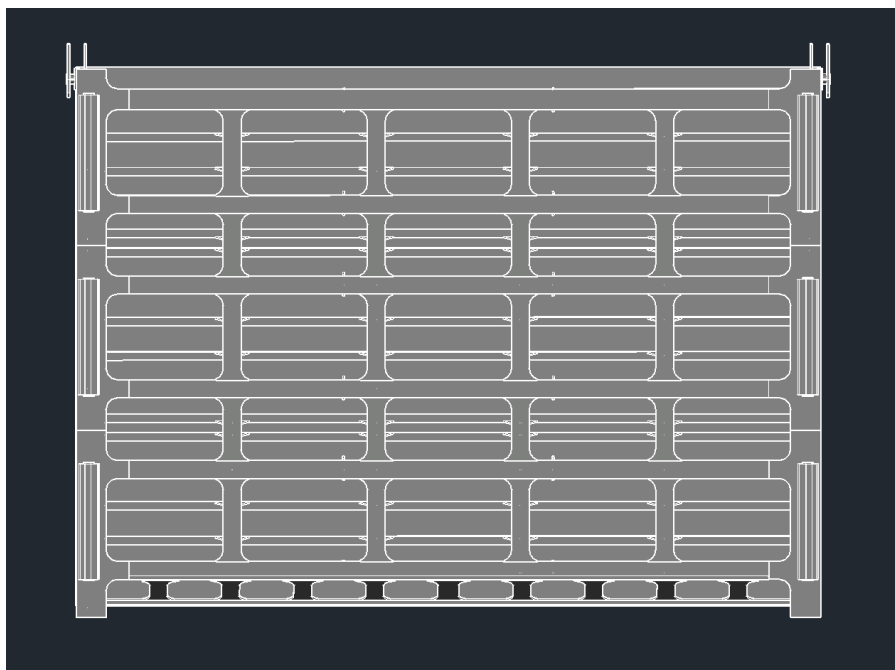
Модель затвора в Autocad вид со стороны НБ
